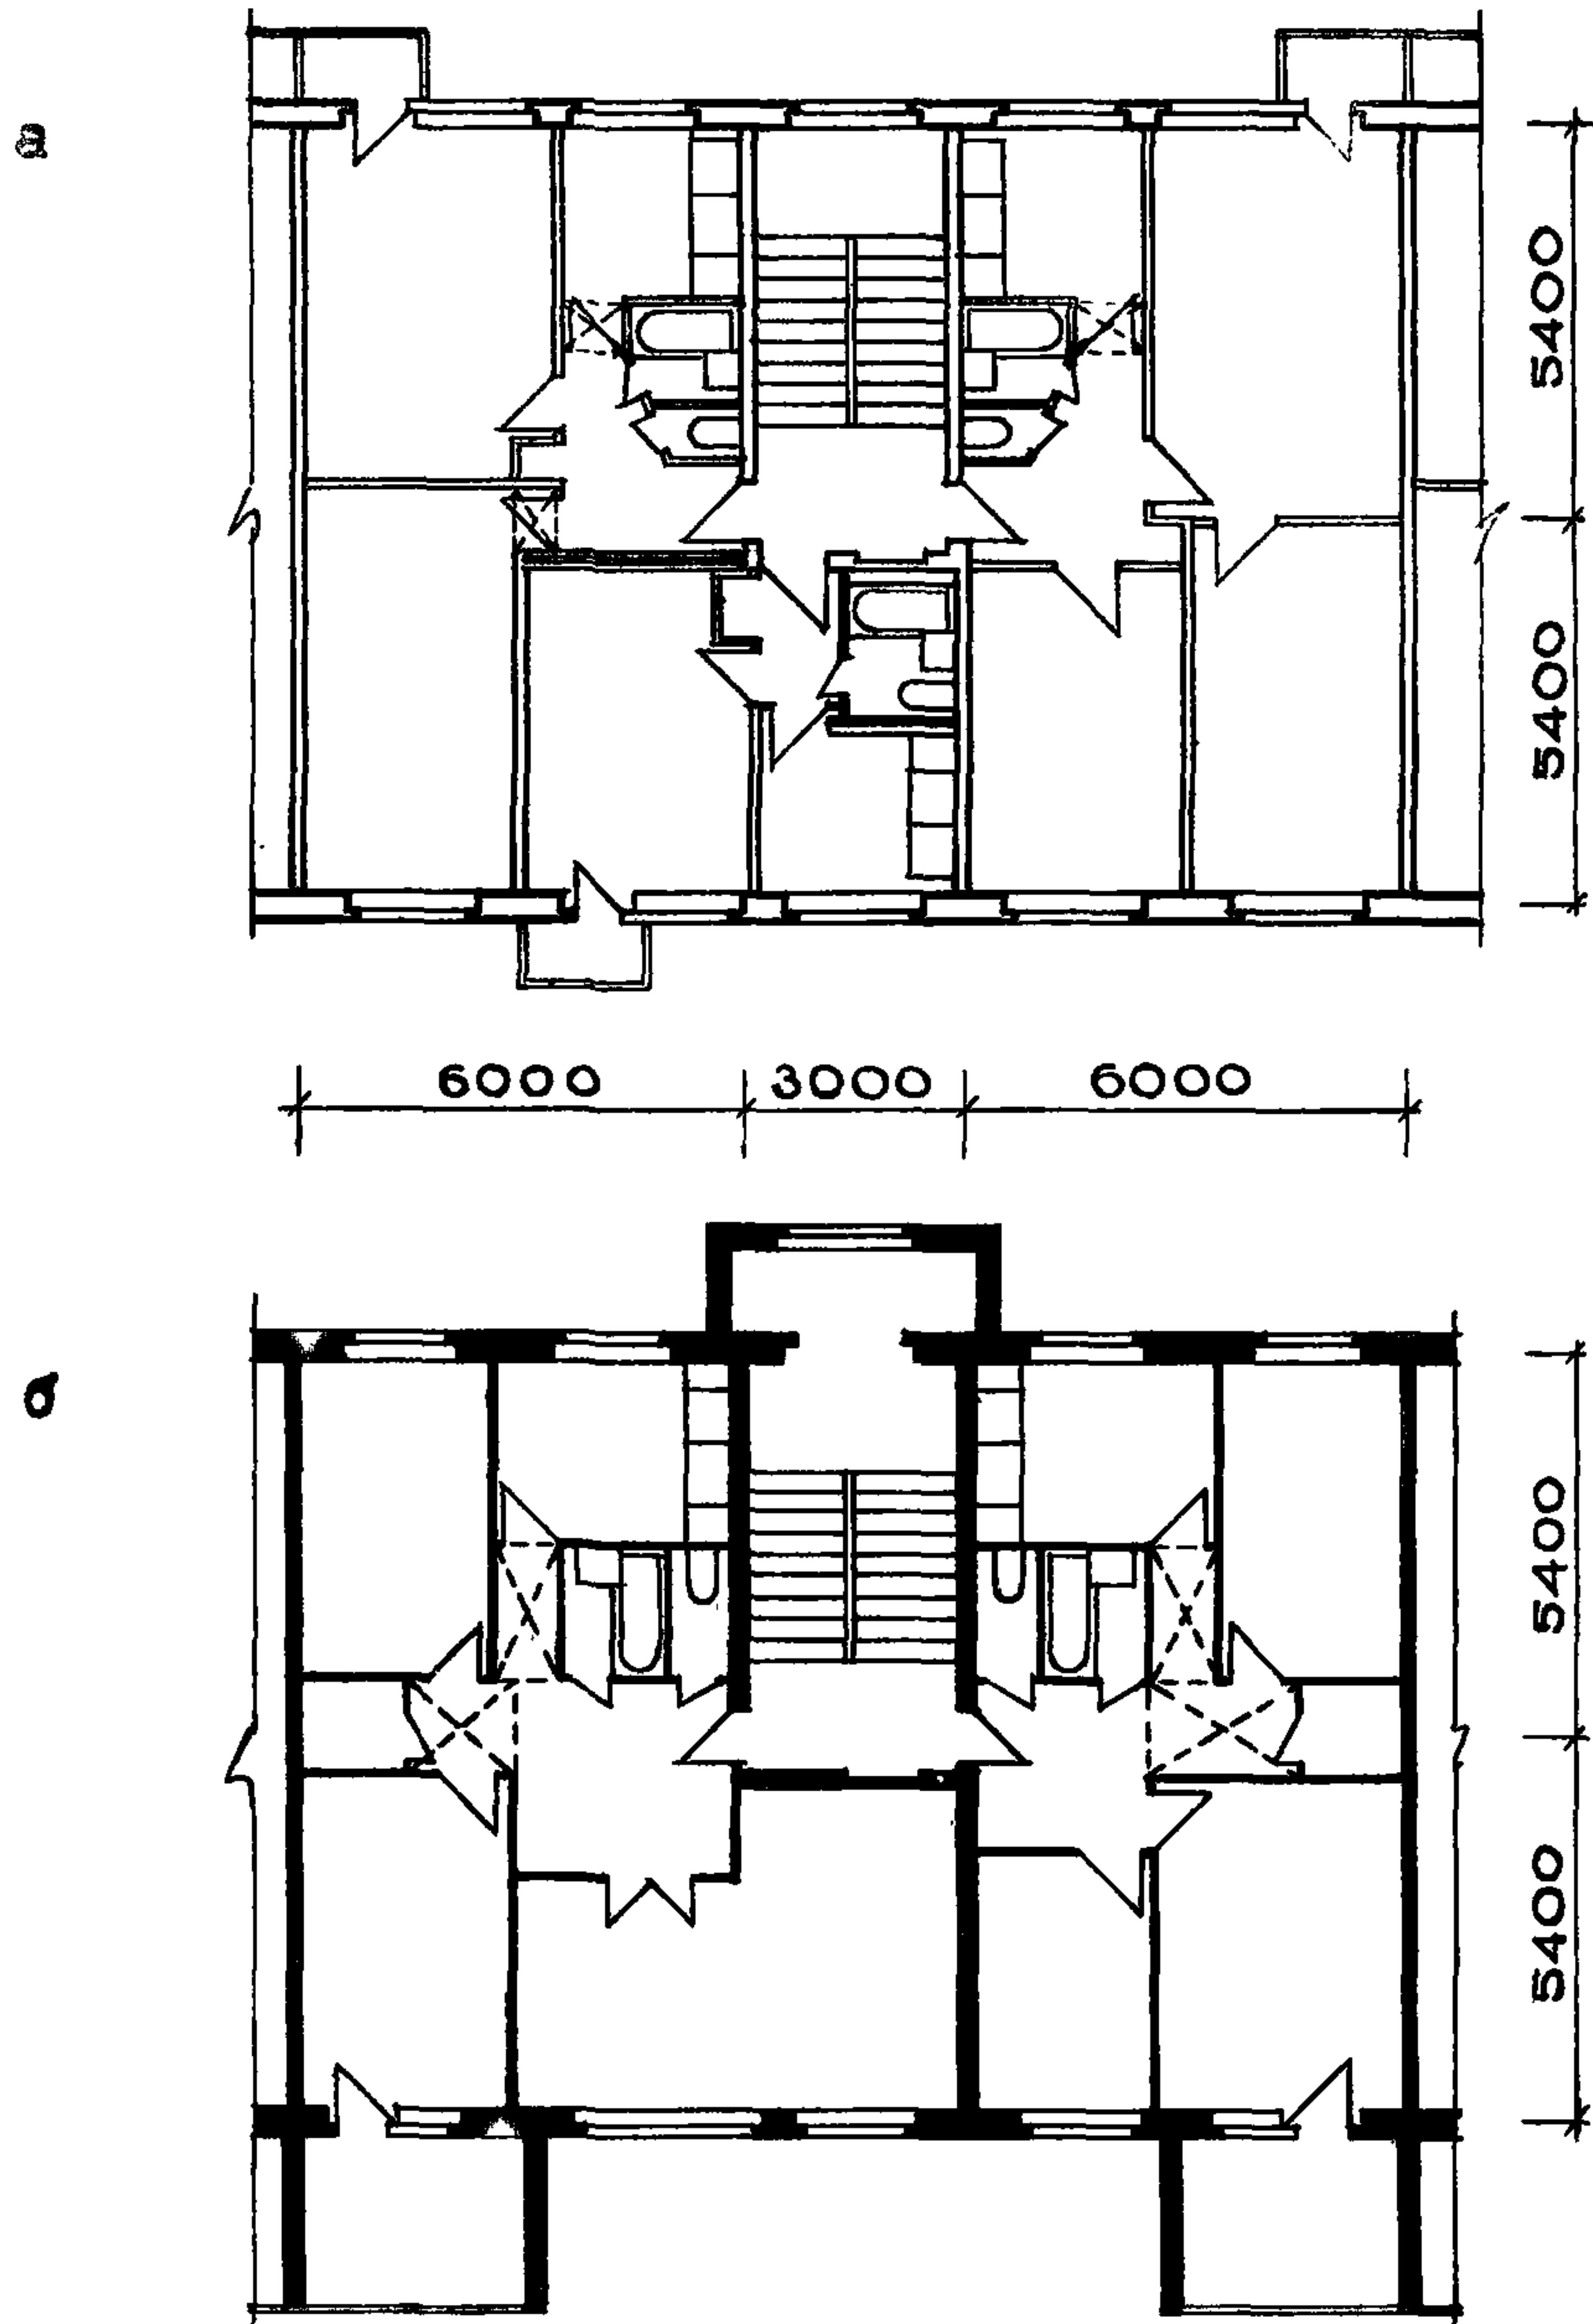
Планировка рядовой секции крупнопанельного дома серии 1-468 со смешанным шагом поперечных несущих стен:
